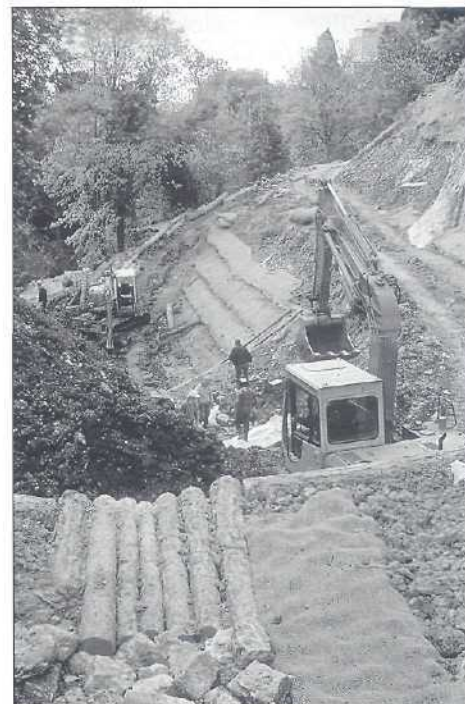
(14.04.99) Vue du chantier en cours de travaux: barrage-bois au premier plan et lits de plants et plançons renforcés avec des treillis de coco en arrière-plan.
